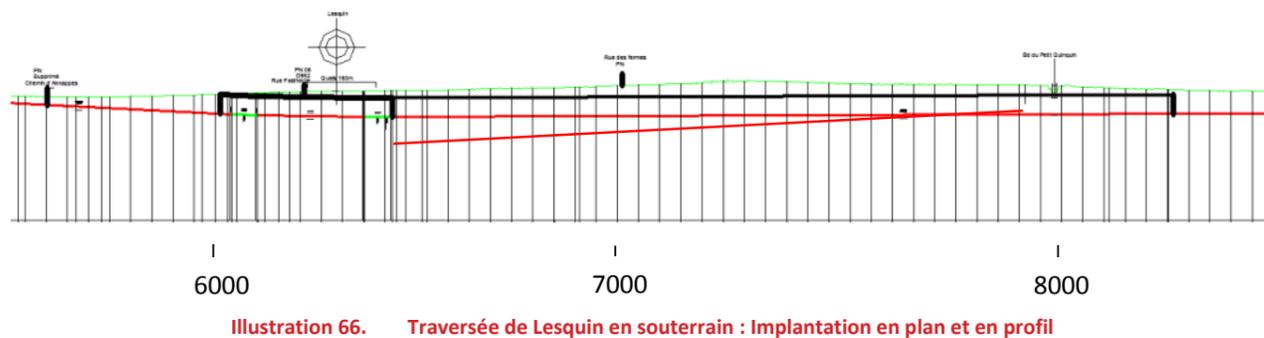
Traversée de Lesquin en souterrain : Implantation en plan et en profil
